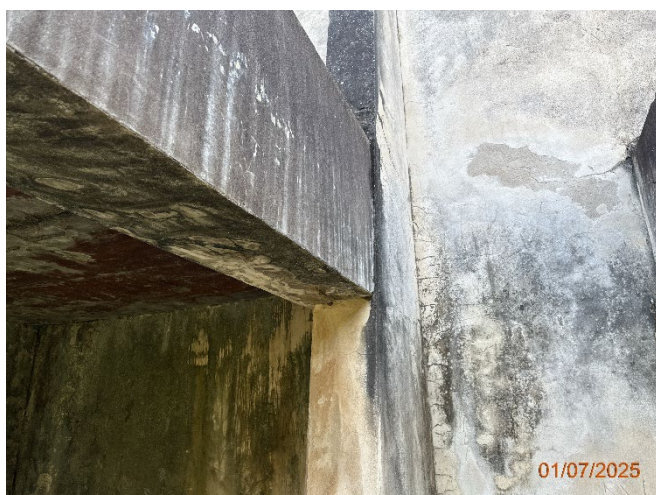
Fissuras e percolação de água na face inferior da viga-calha.
